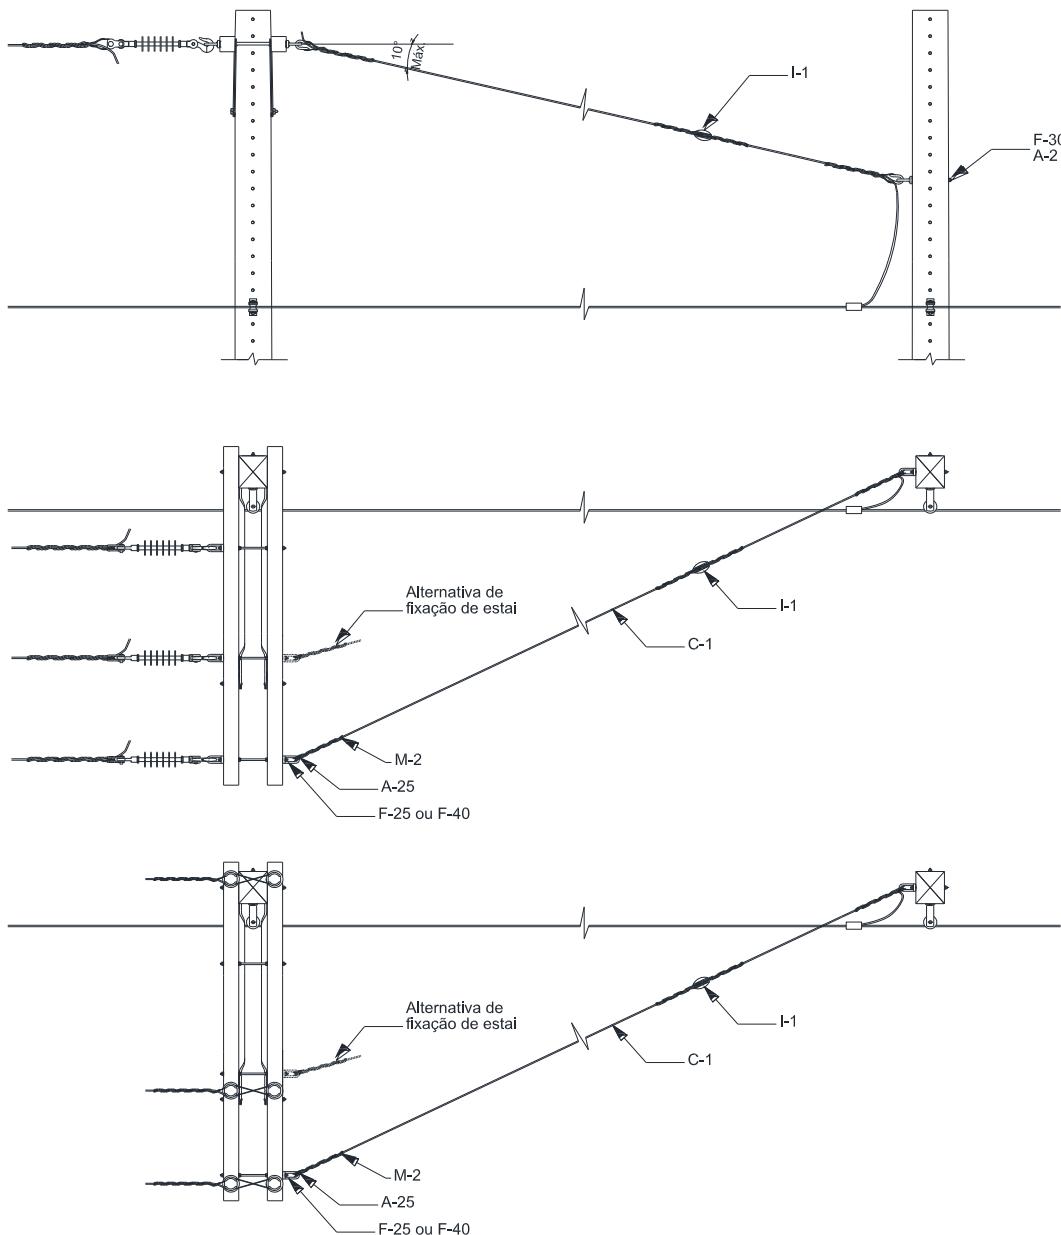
Estaiaimento – Estai de cruzeta a poste
